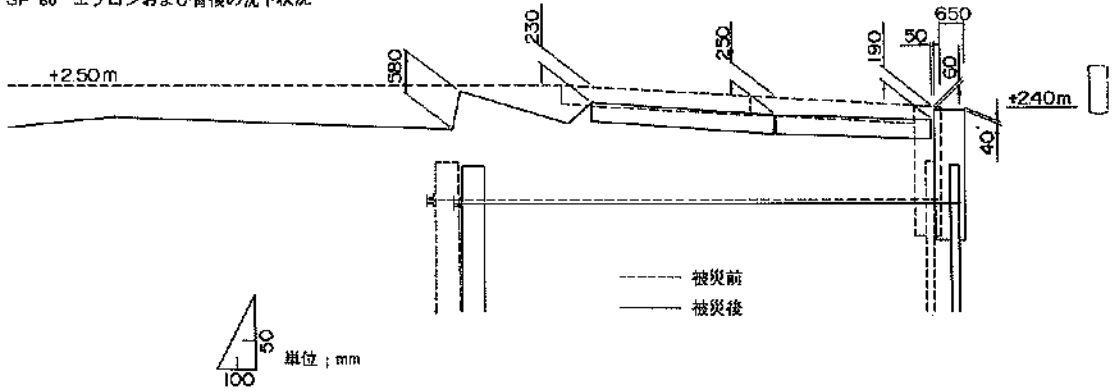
被災状況断面図 (⑤中央埠頭物揚場-3.5m)
